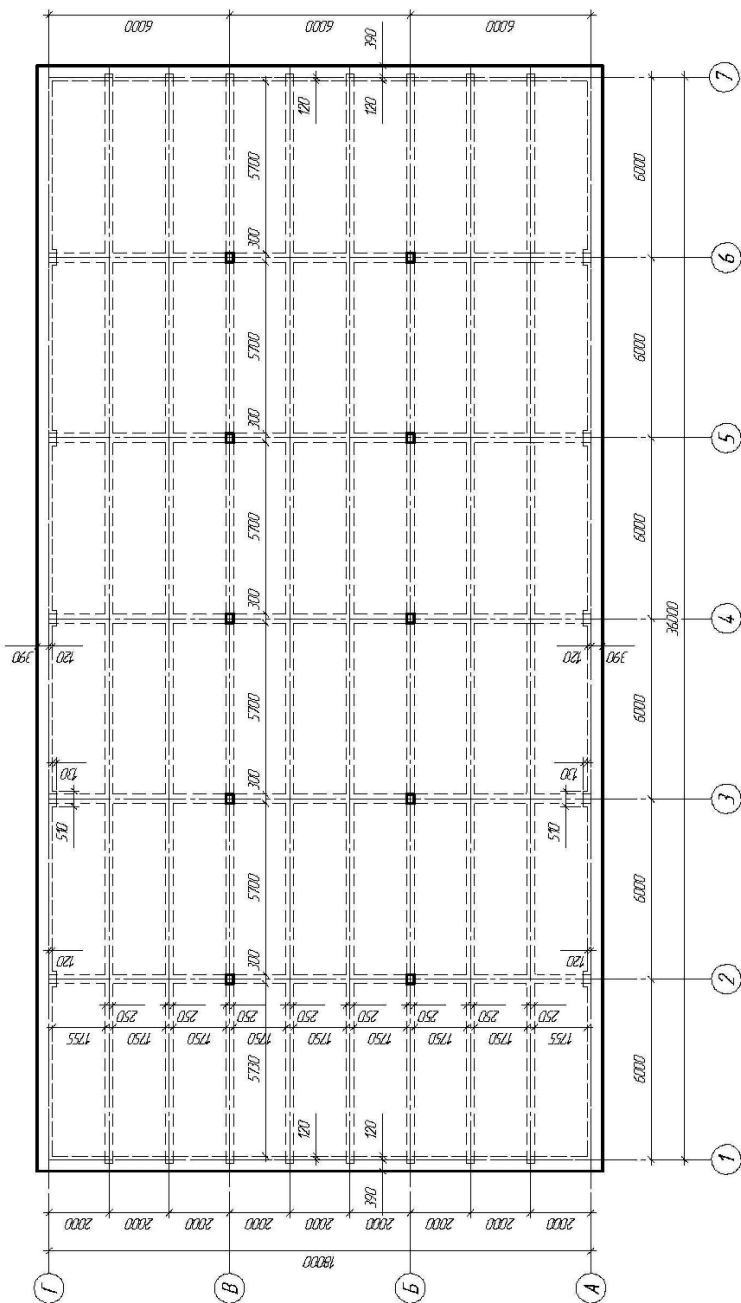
План монолитного ребристого перекрытия с балочными плитами
